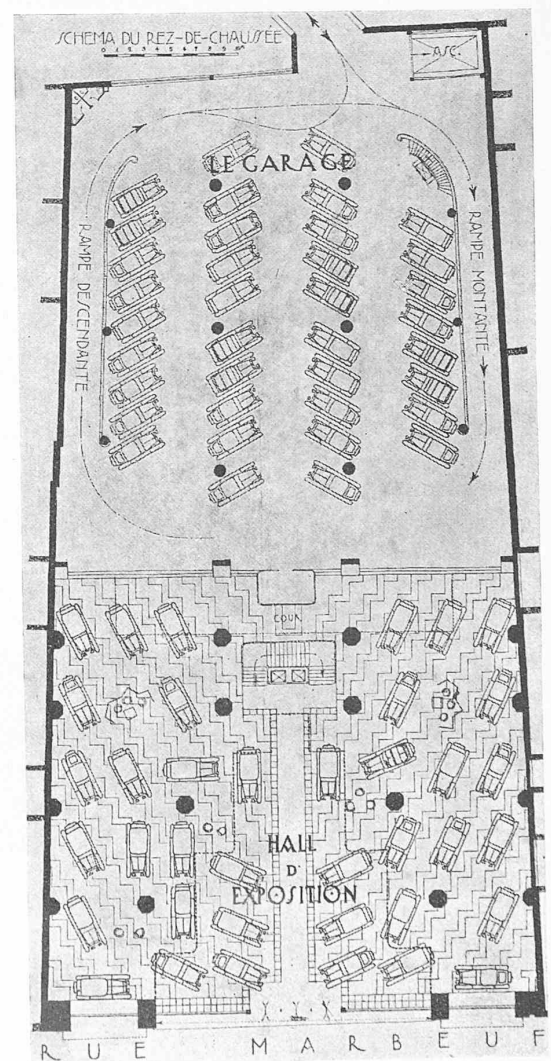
Grundriss vom Erdgeschoss. — Masstab 1 : 500.
